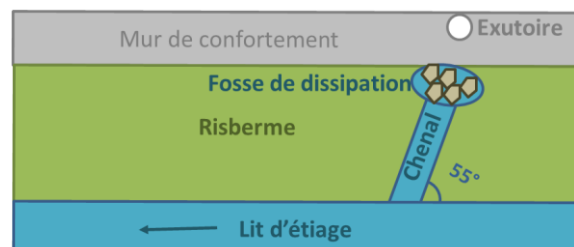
Aménagement de la risberme au droit des exutoires pluviaux en hauteur
